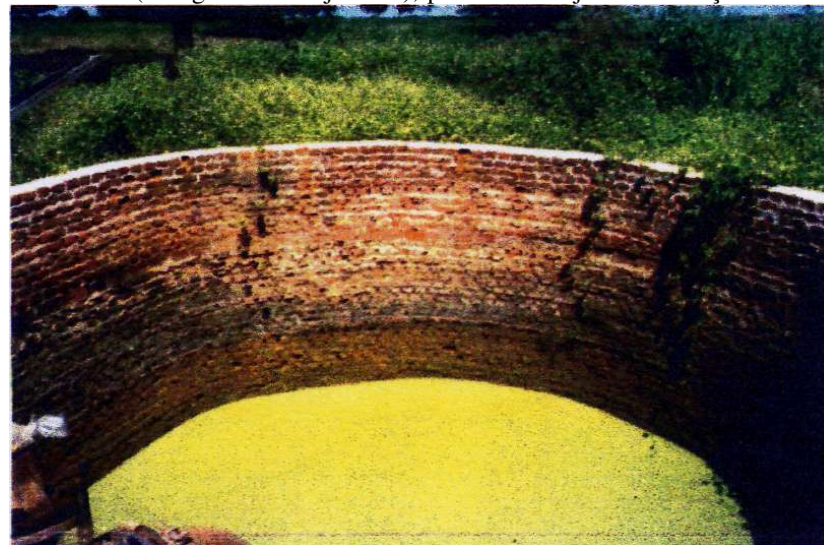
Parte de um cacimbão, localizado na jusante do açude Canta Galo.
